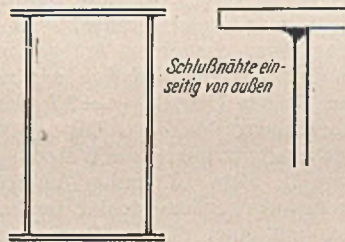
Geschweißter Hohlträger aus ebenen Blechen.
